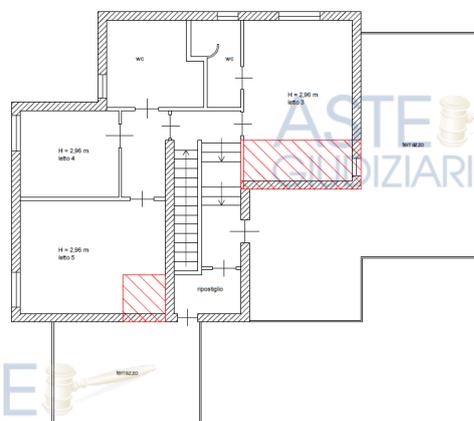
Planimetria piano primo stato di fatto con INDICAZIONE IN ROSSO DEGLI
